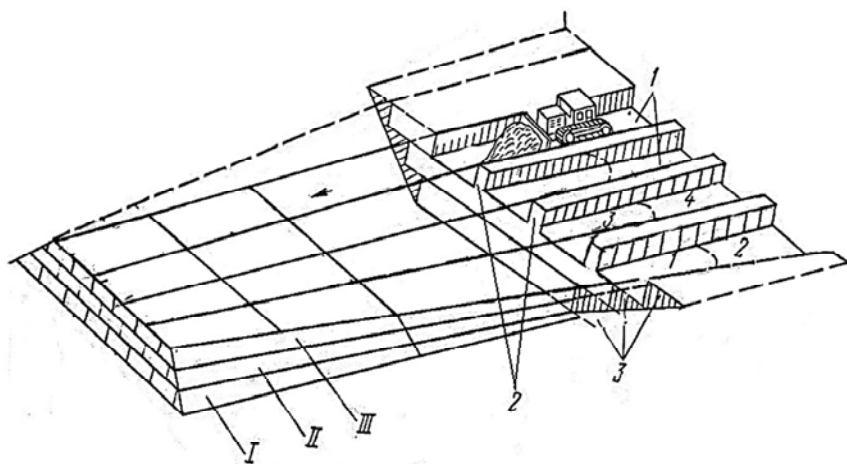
Разработка грунта бульдозером из выемки в насыпь:
